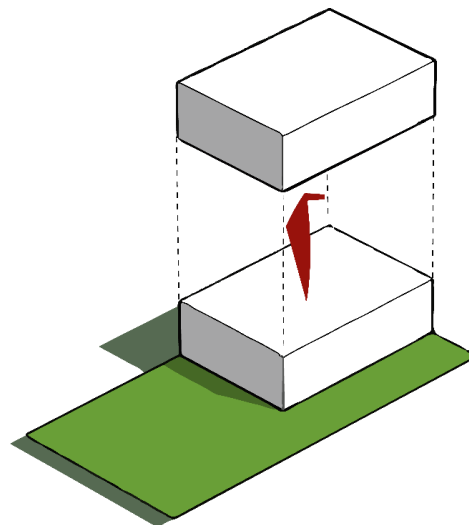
Incorporar módulo básico en planta alta. Elaboración Propia 2019.
